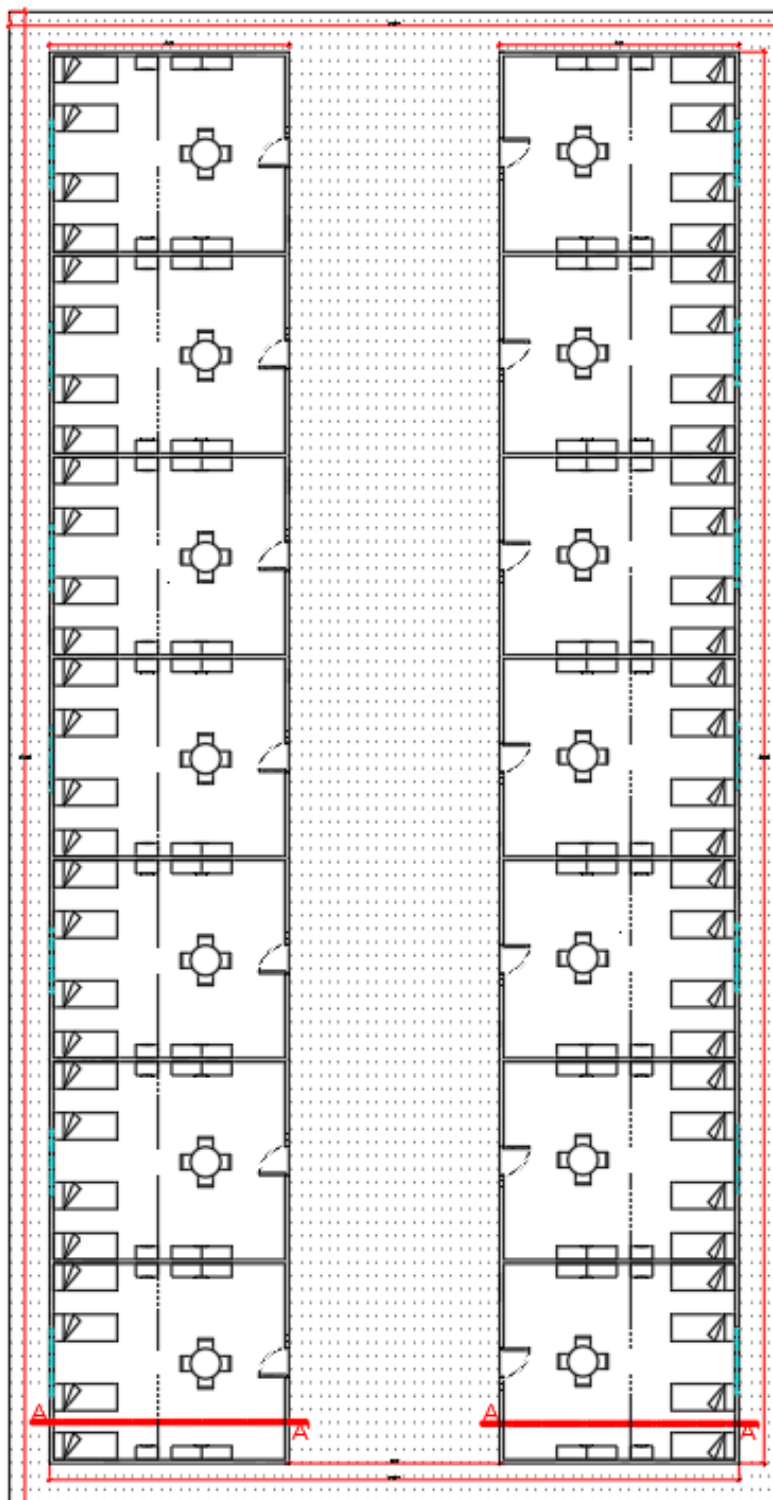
Plano de viviendas de tipología B: Elaboración propia.
